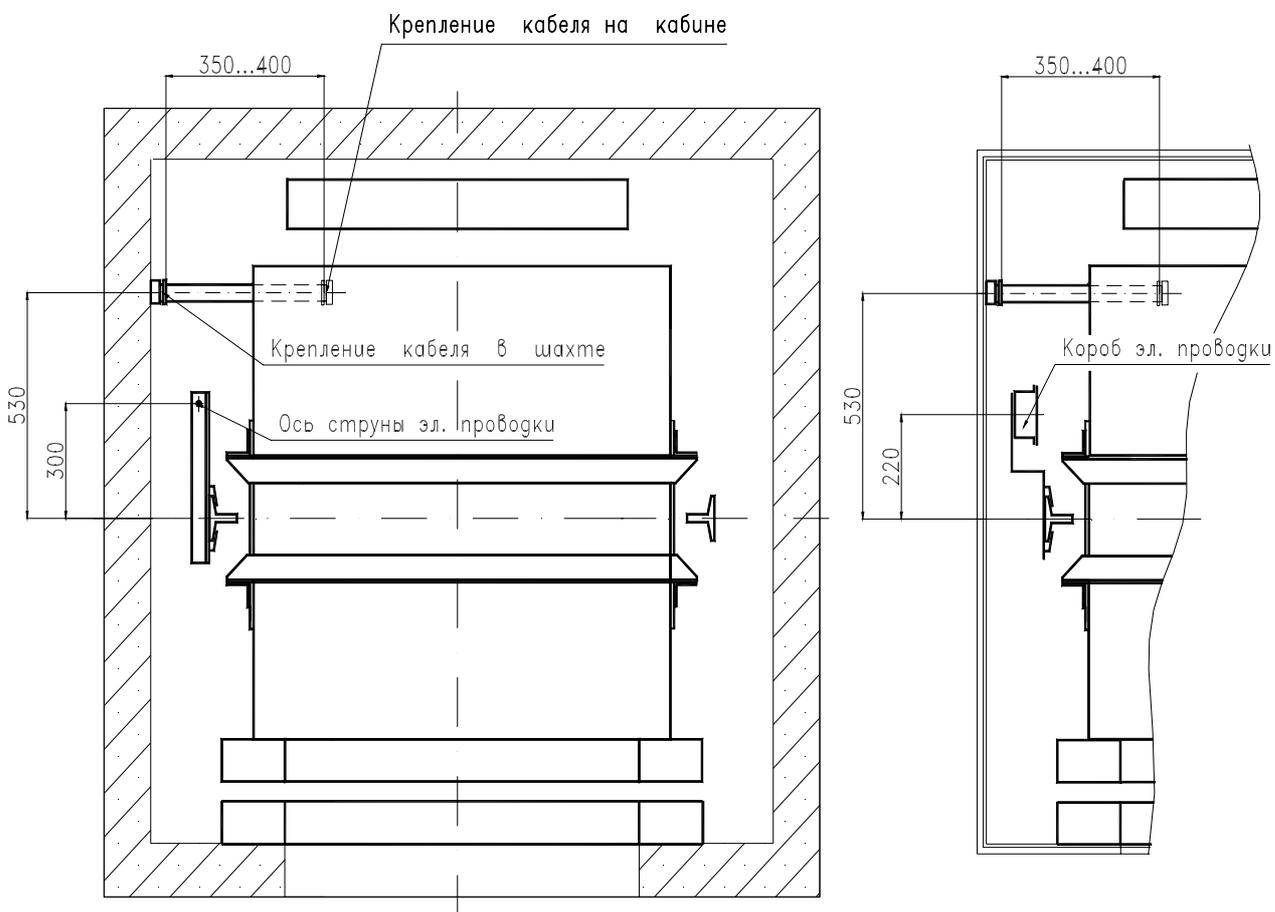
Крепление плоского подвесного кабеля и электропроводки.
